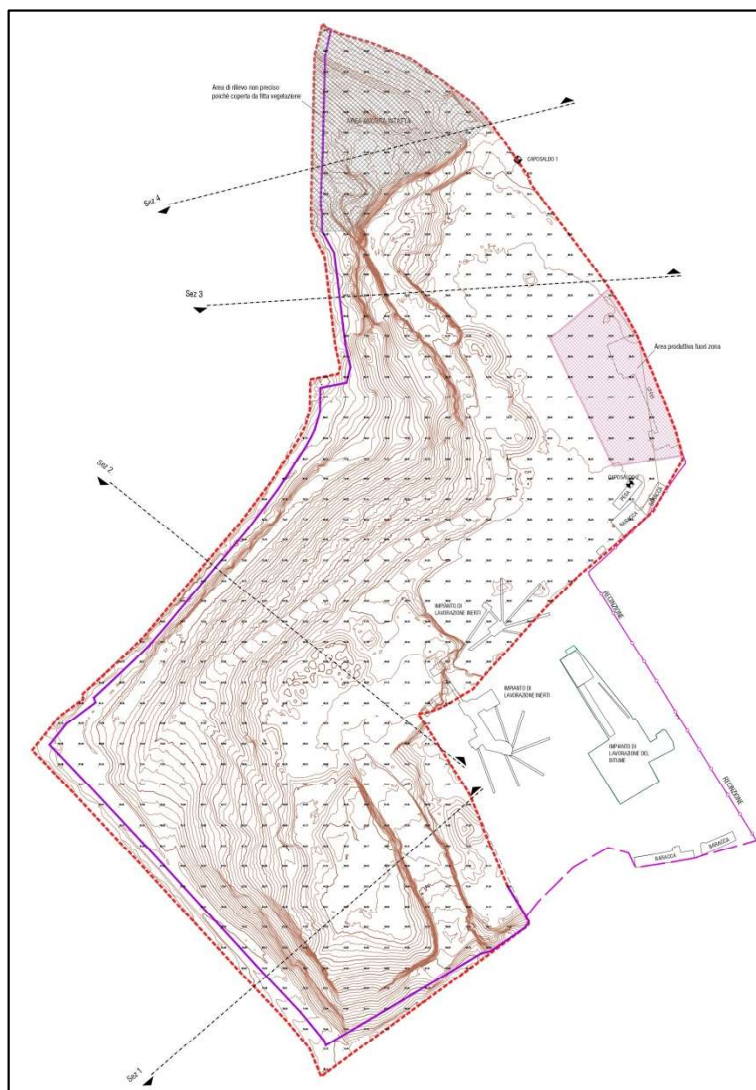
Estratto Elab.02-Planimetria dello stato attuale
